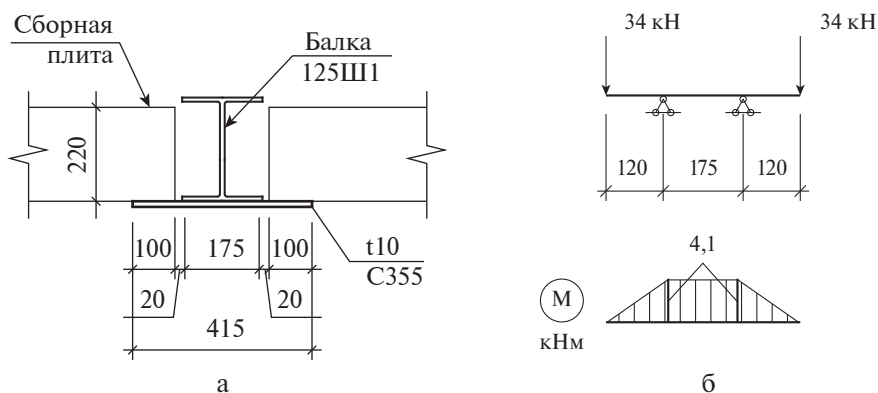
Схема опирания (а) и расчетная схема (б) листа, приваренного к нижней полке балки
